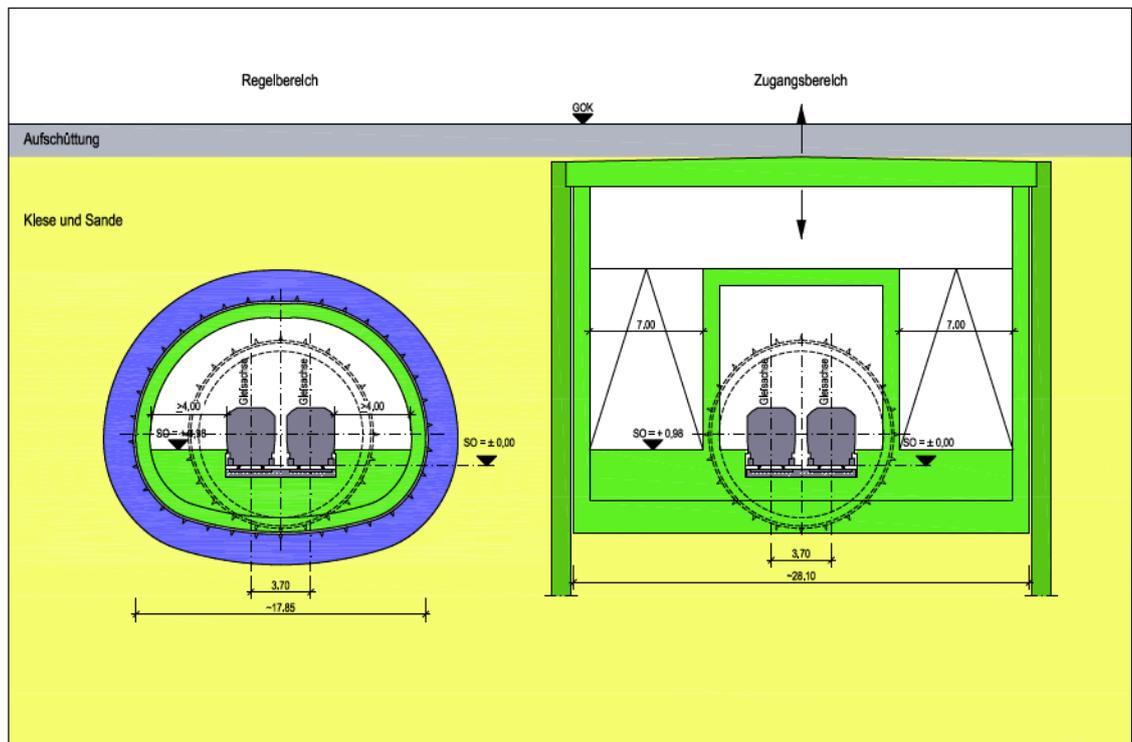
Systemdarstellung Variante 2 – Bahnsteig geschlossene Bauweise + Zugang offene Bauweise
